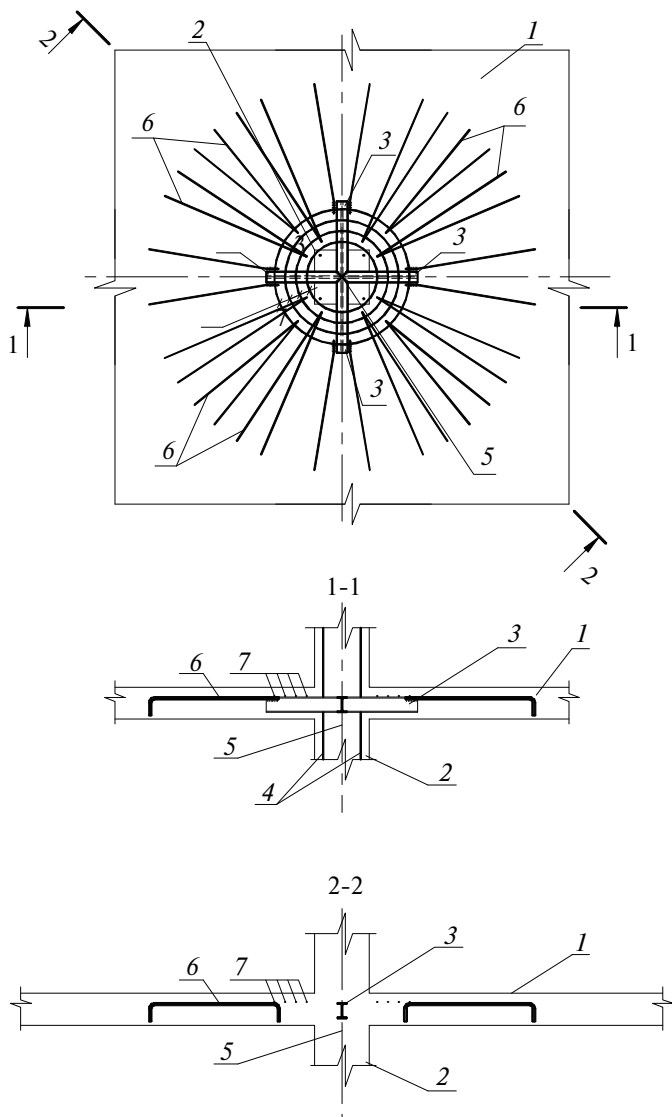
Скрытая консоль из двутавра, снабженная радиальной и кольцевой арматурой: 1 – плоская плита перекрытия; 2 – колонна; 3 – ветви скрытой консоли; 4 – арматура колонны; 5 – ось узла скрепления ветвей скрытой консоли и ось колонны; 6 – радиальная арматура; 7 – кольцевая арматура
